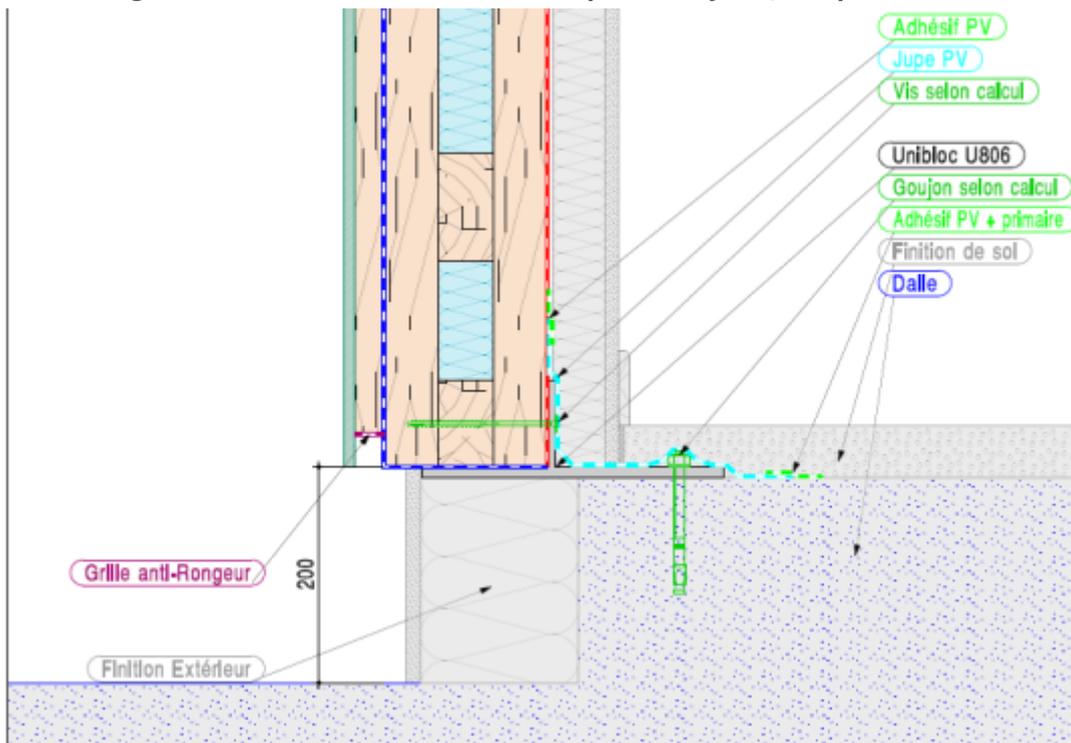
Jonction en nez de dalle sur béton en pied de façade / Coupe verticale
